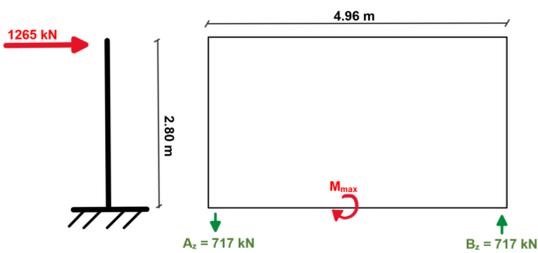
Erdbebenbeanspruchung: Modellbildung der Tragwände
